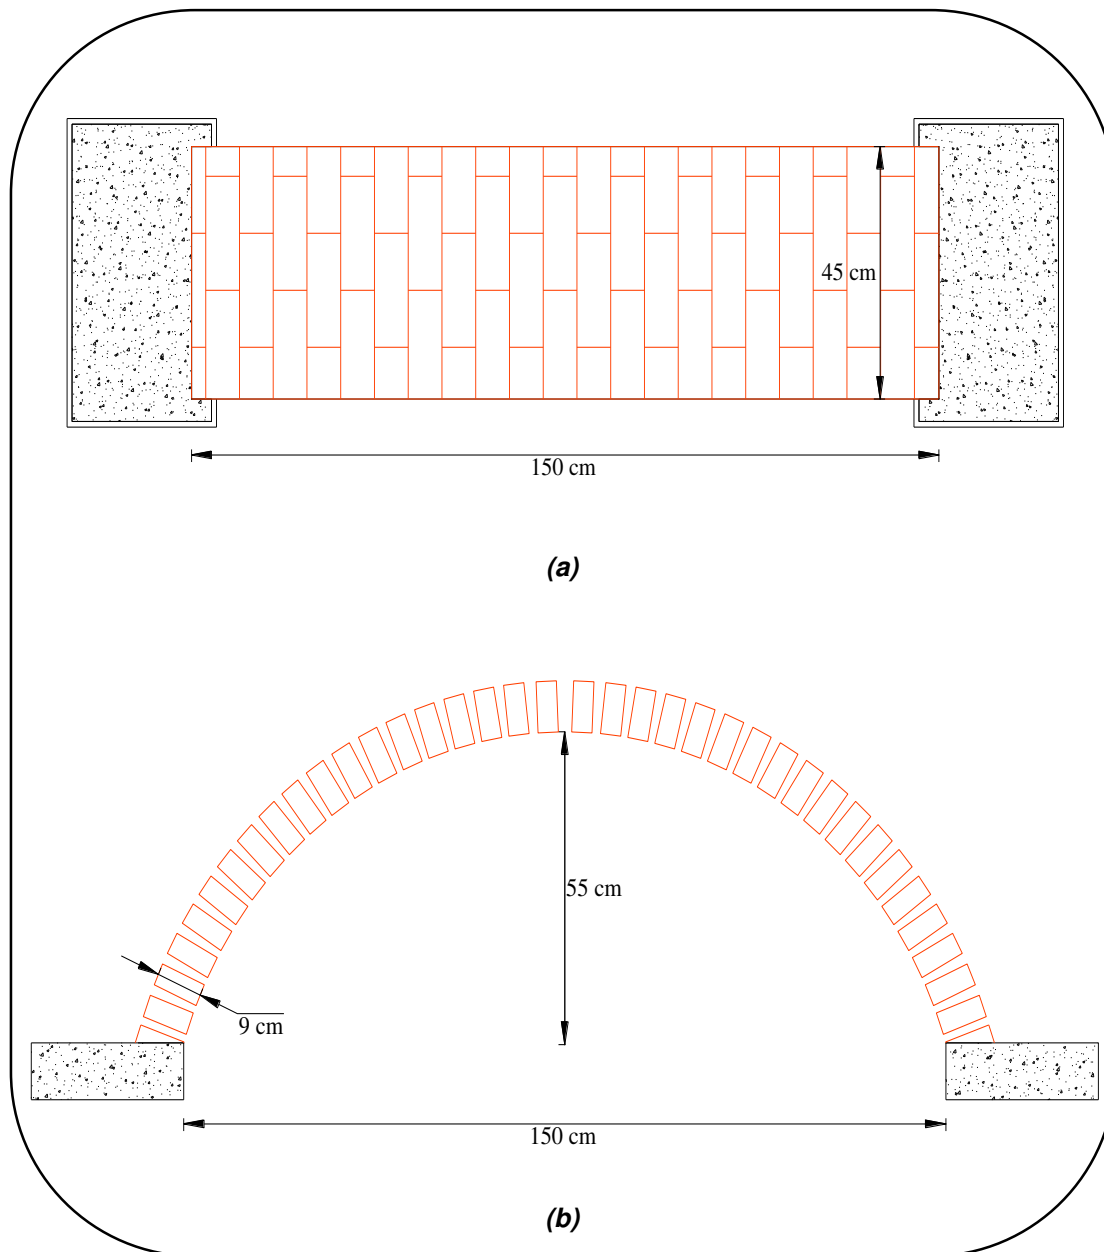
Geometría del arco de rebajado: a) Vista en planta; b) Vista lateral.
